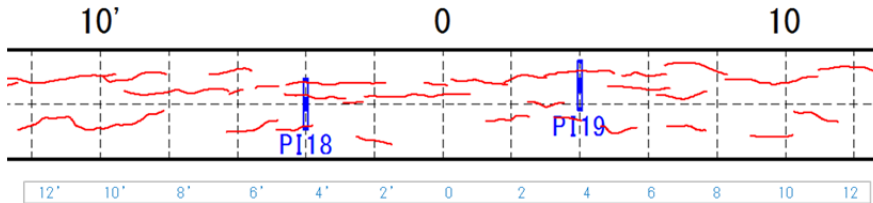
G6 桁下面の橋軸方向ひび割れの計測位置
